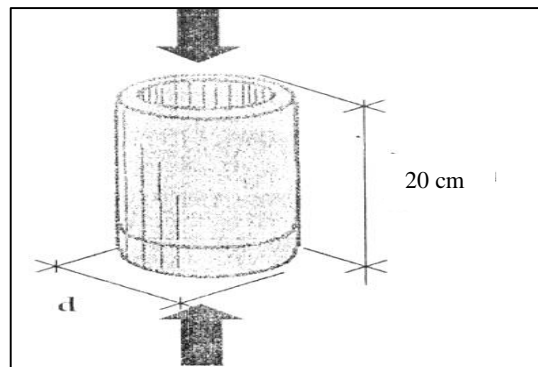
Dimensiones de las probetas para el ensayo de compresión paralela
